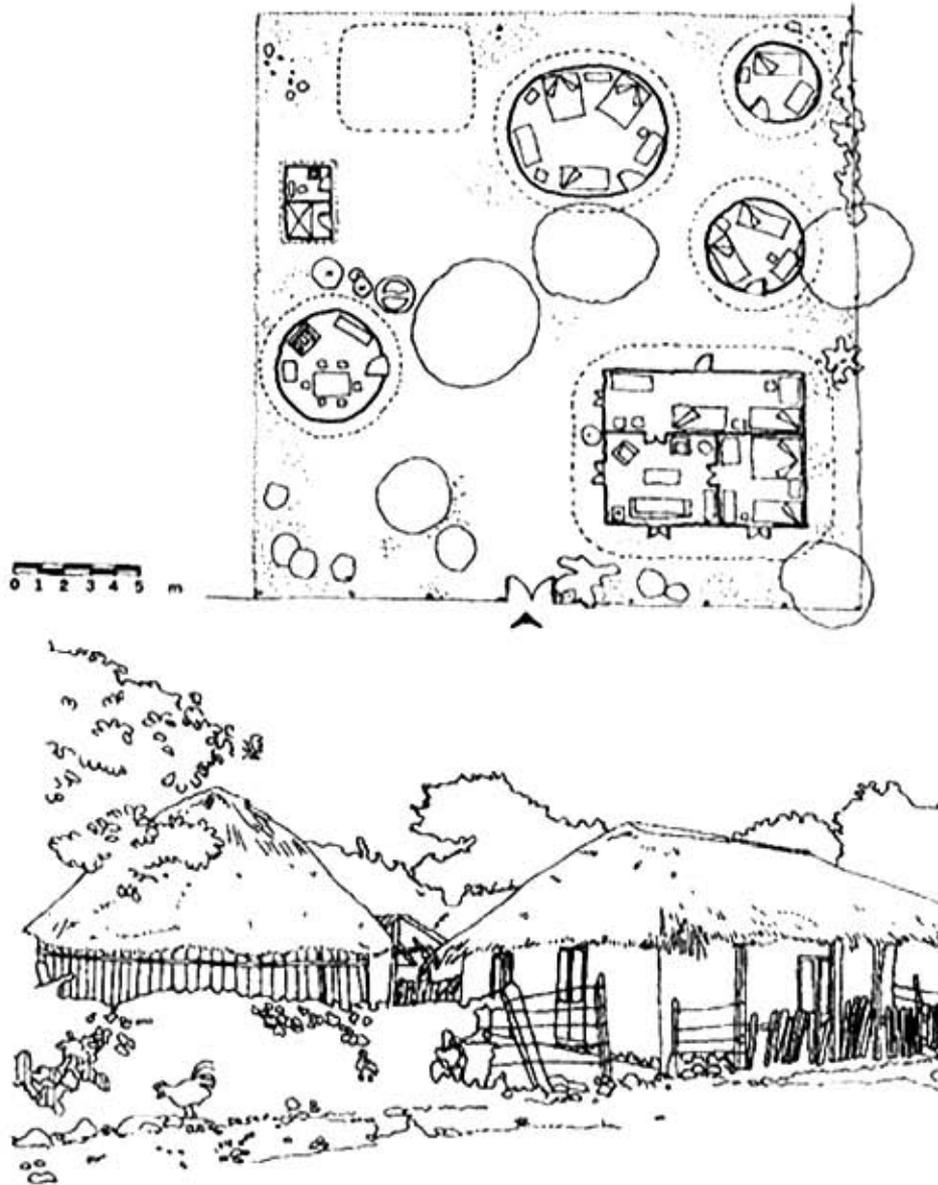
Vivienda actual en la huasteca mexicana (López Morales, 1987).
